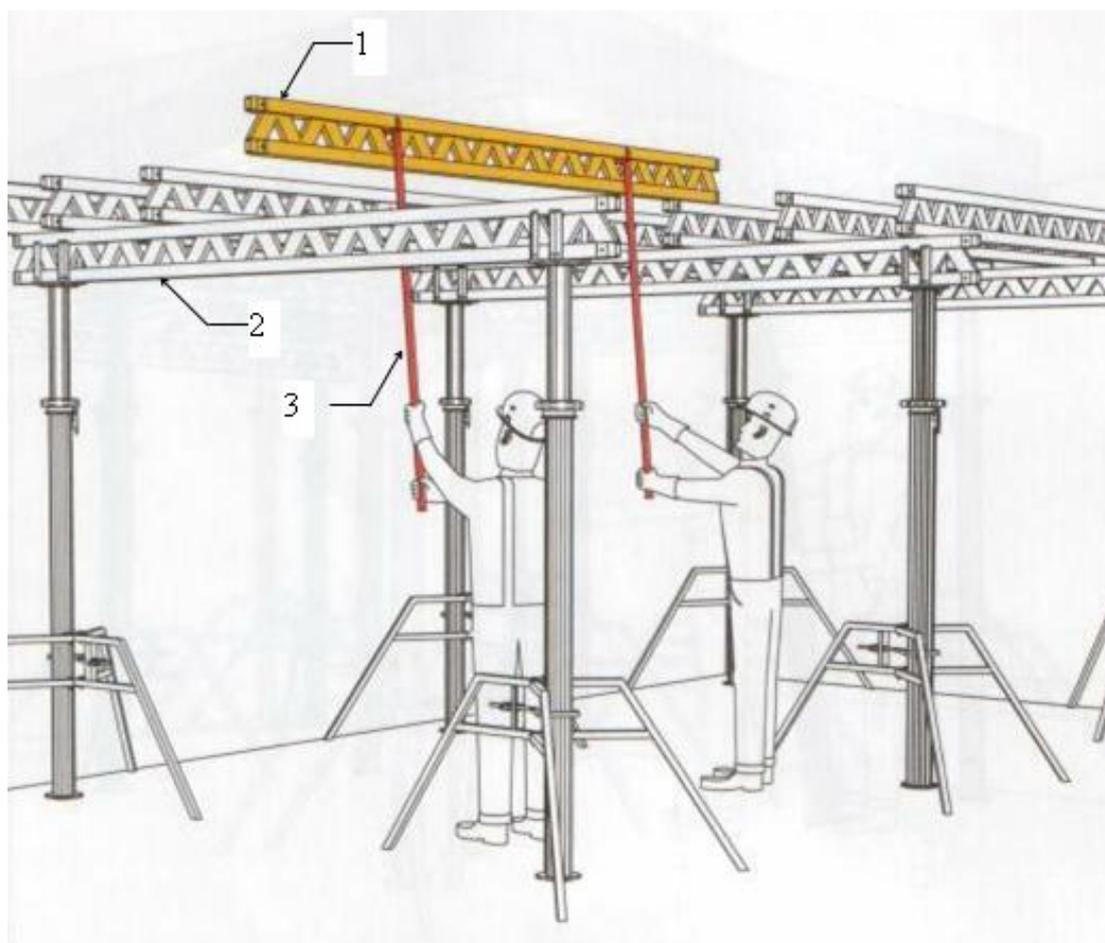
Монтаж второстепенных балок: 1 – второстепенная балка; 2 – продольная балка; 3 – монтажная штанга
